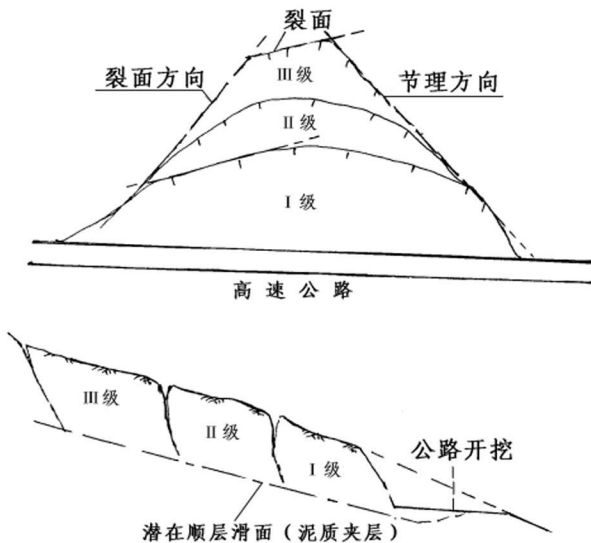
顺层滑坡扩展模式(上平面图,下纵断面图)
